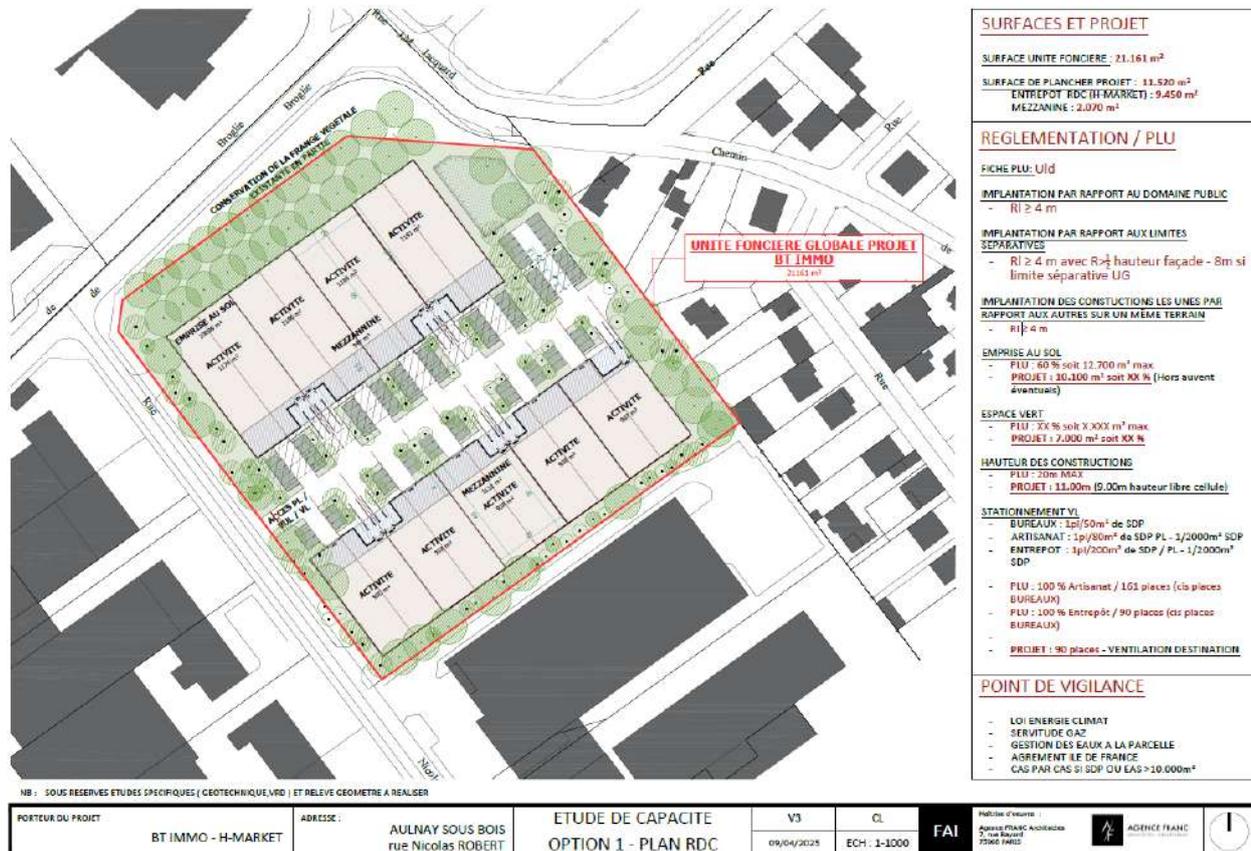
plan de masse RDC du projet du 09/04/2025 (source : plan transmis par le client)
